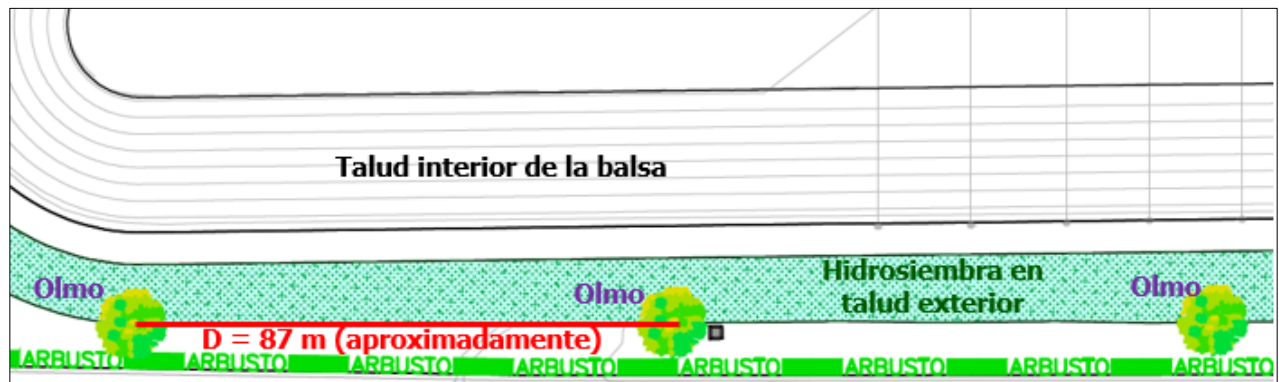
Detalle de plantación de los olmos al pie del talud de la balsa.
